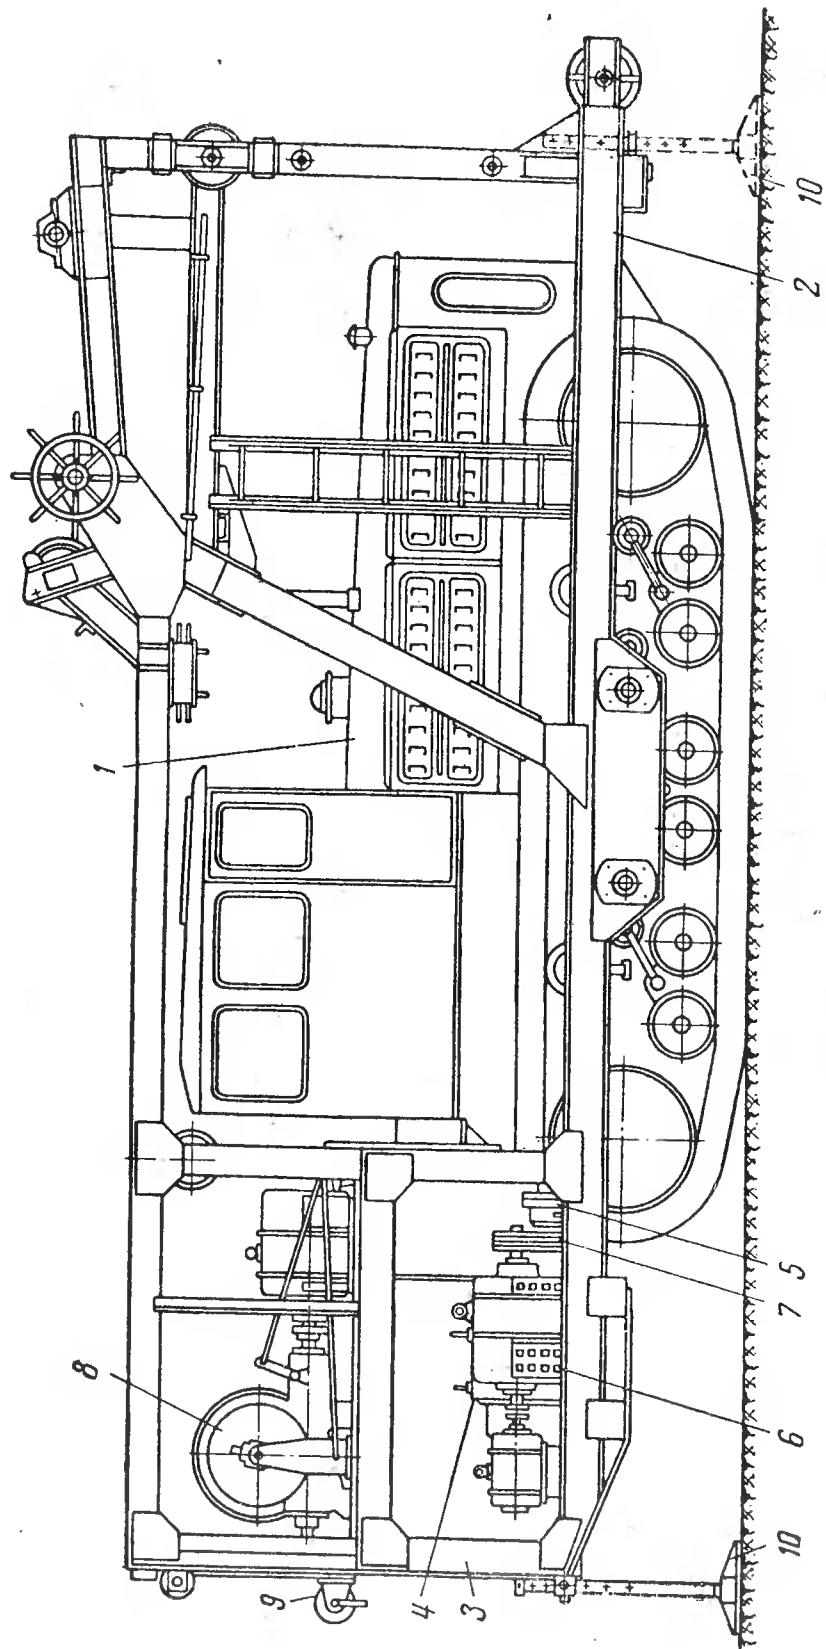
Вибровдавливающий погружатель ВВПС-32/19.
